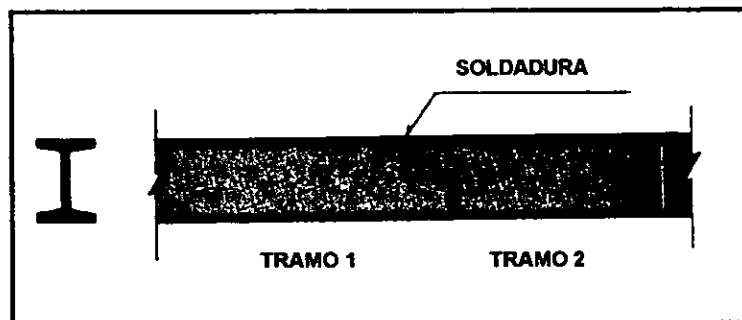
Soldadura en perfil estructural de pilote de acero.
